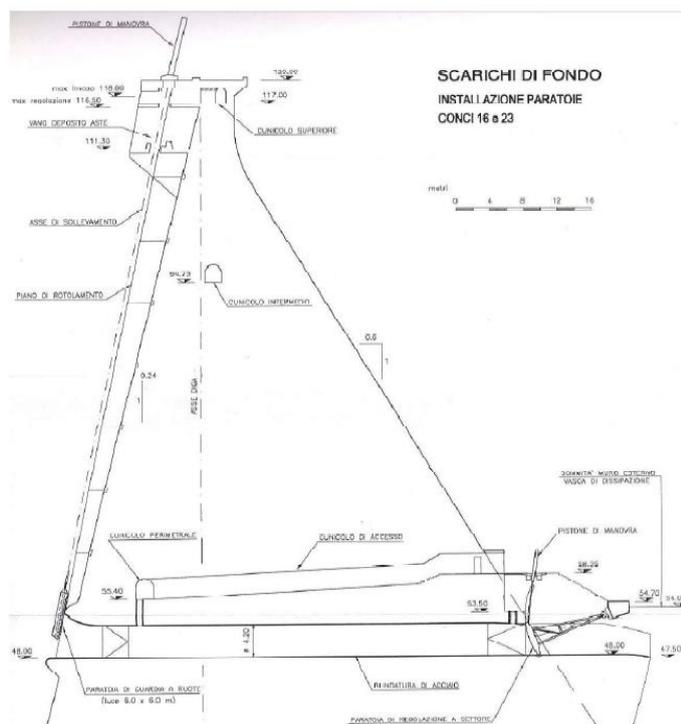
Sezione scarico di fondo Diga Cantoniera
